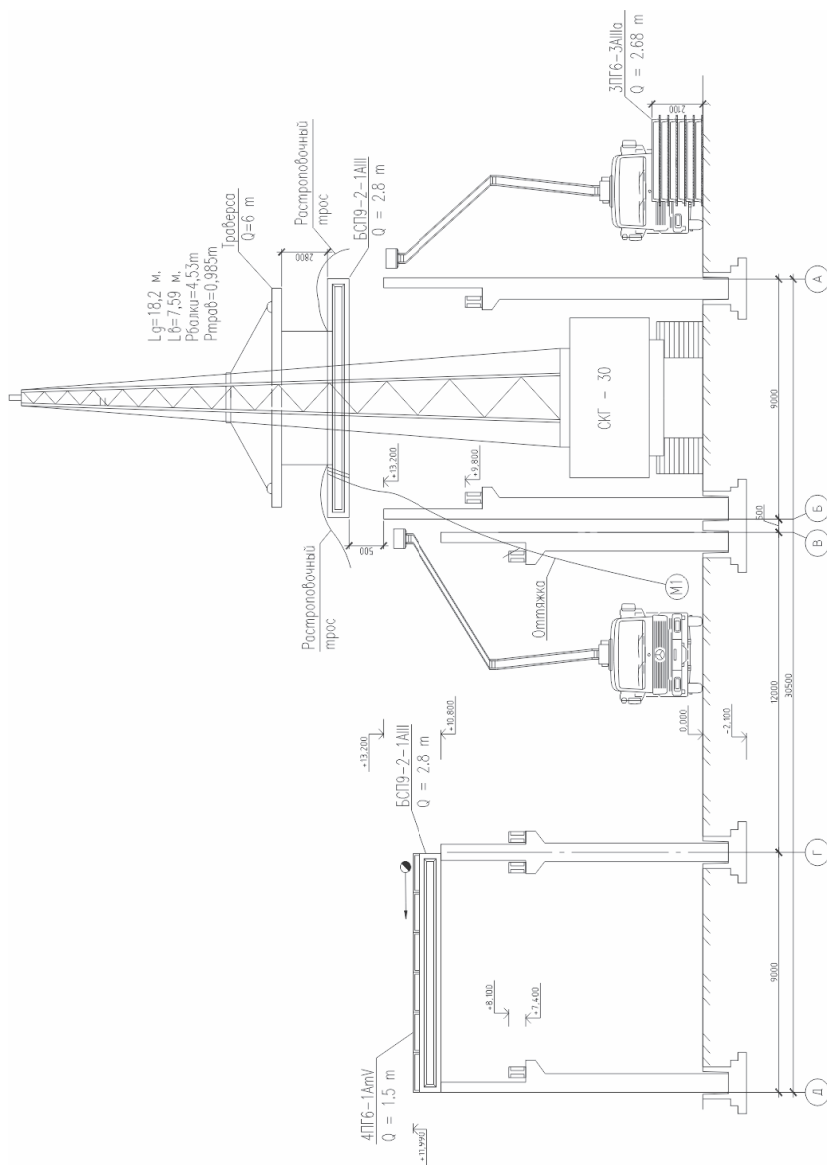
Схема процесса монтажа балок покрытия, выполнена А.С. Тарасовой, гр. ПГС-09-3
